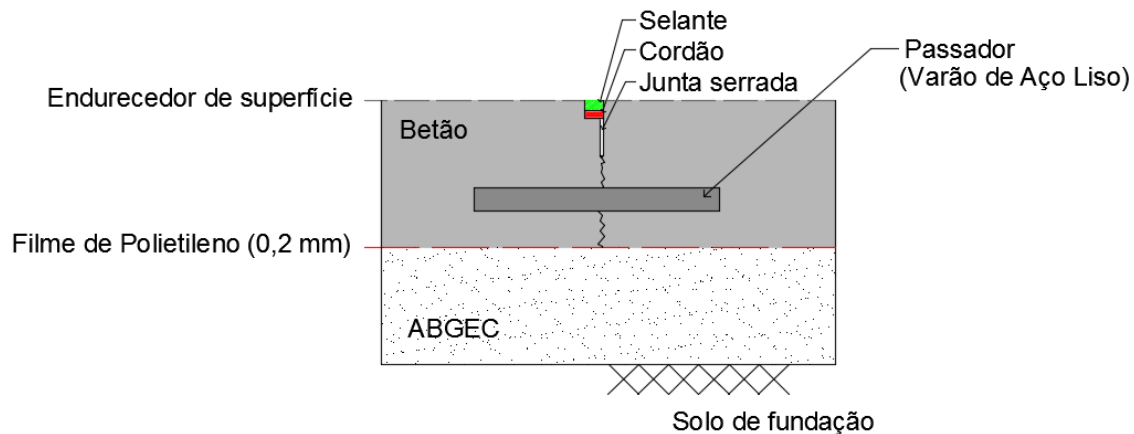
Exemplo de um perfil de pavimento rígido simples com passadores
